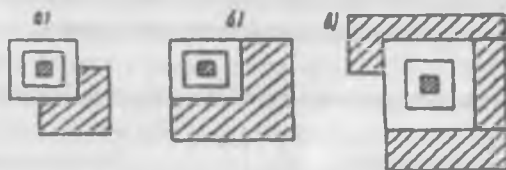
Способы вскрытия столбчатых фундаментов:
